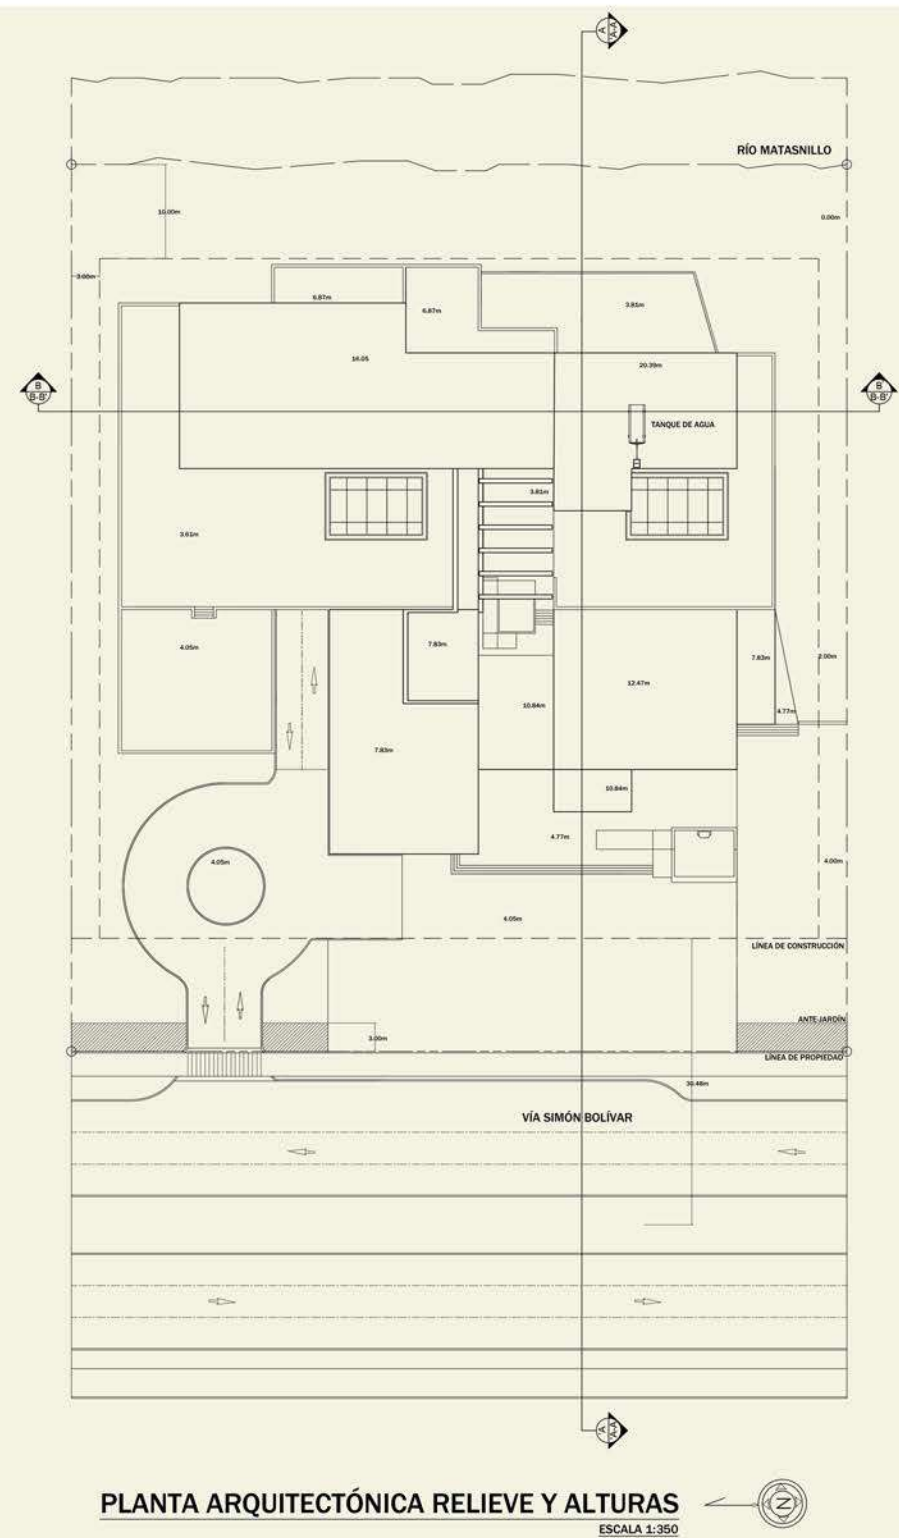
Planta arquitectónica relieve y alturas. (Escala para plano 2x3)
